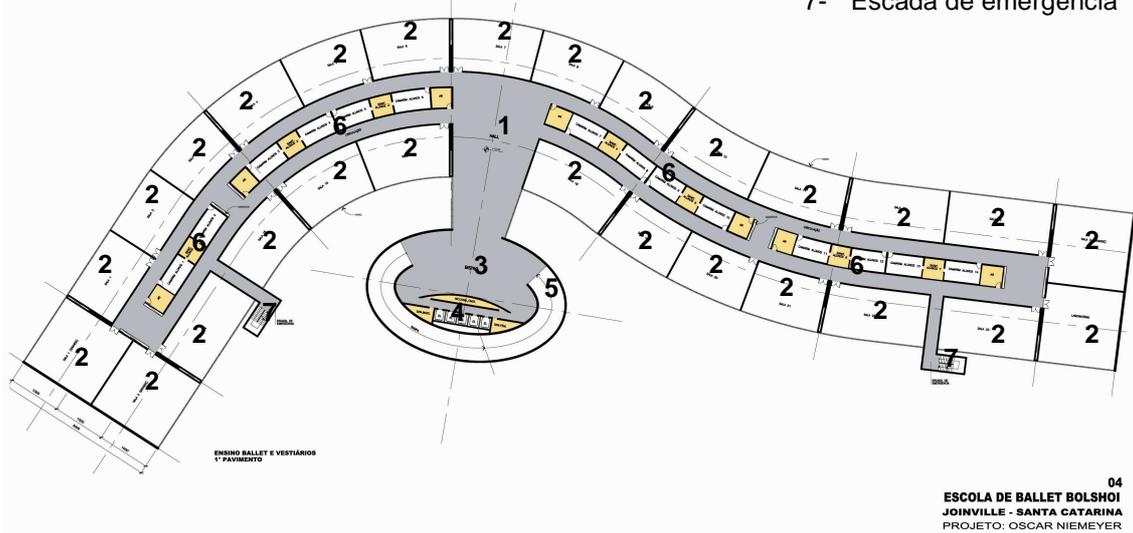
Planta segundo pavimento – escola de dança: estúdios e vestiários
